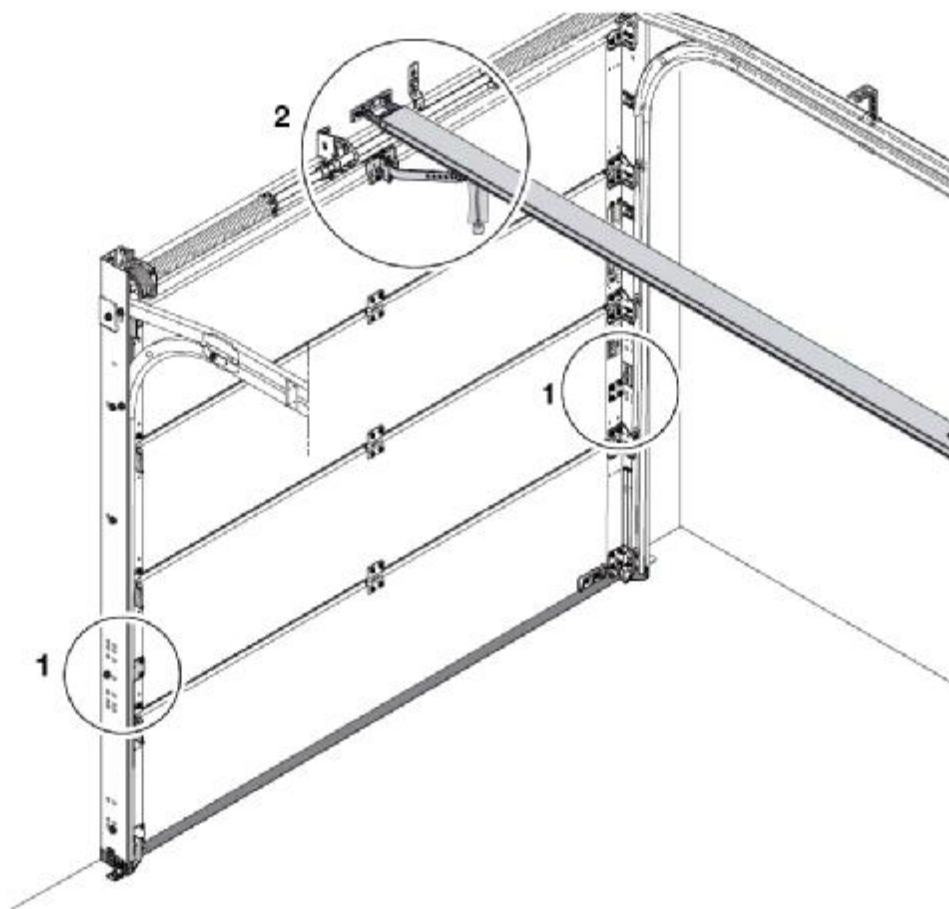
Mechanizm blokowania skrzydła bramy z napędem przed podważeniem
